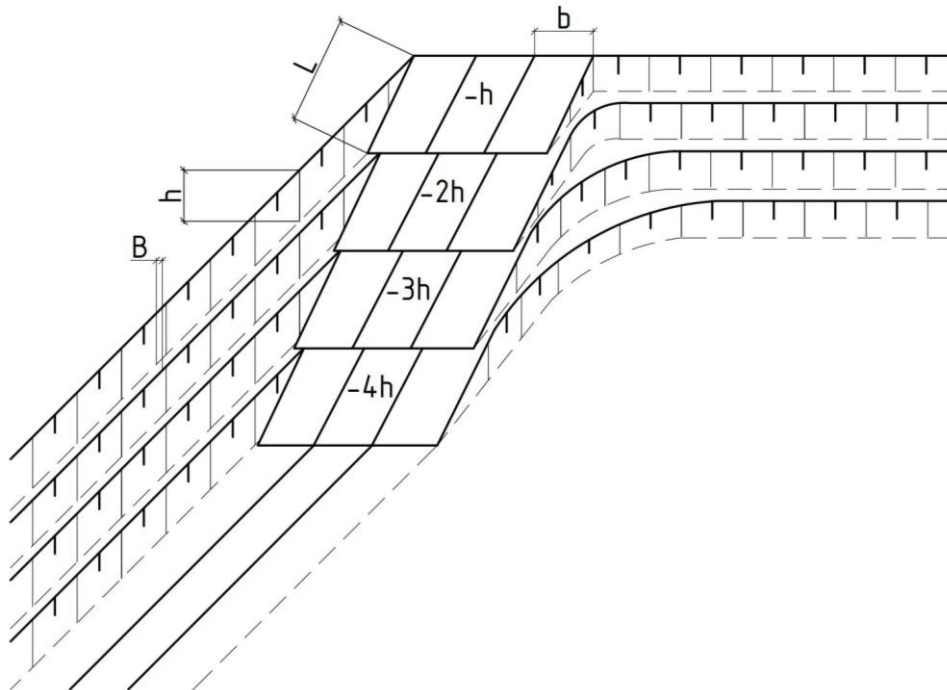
Схема проходки з’їзду фрезерним комбайном: L – довжина з’їзду; b – ширина фрези; h – висота уступу (потужність шару, що фрезерується); B – ширина бічної стінки.
